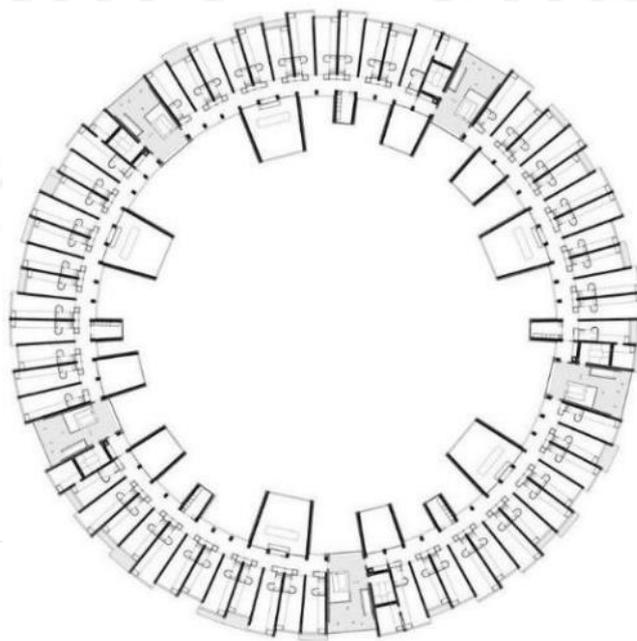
Plano de planta de nivel peatonal del Tietgenkollegiet
